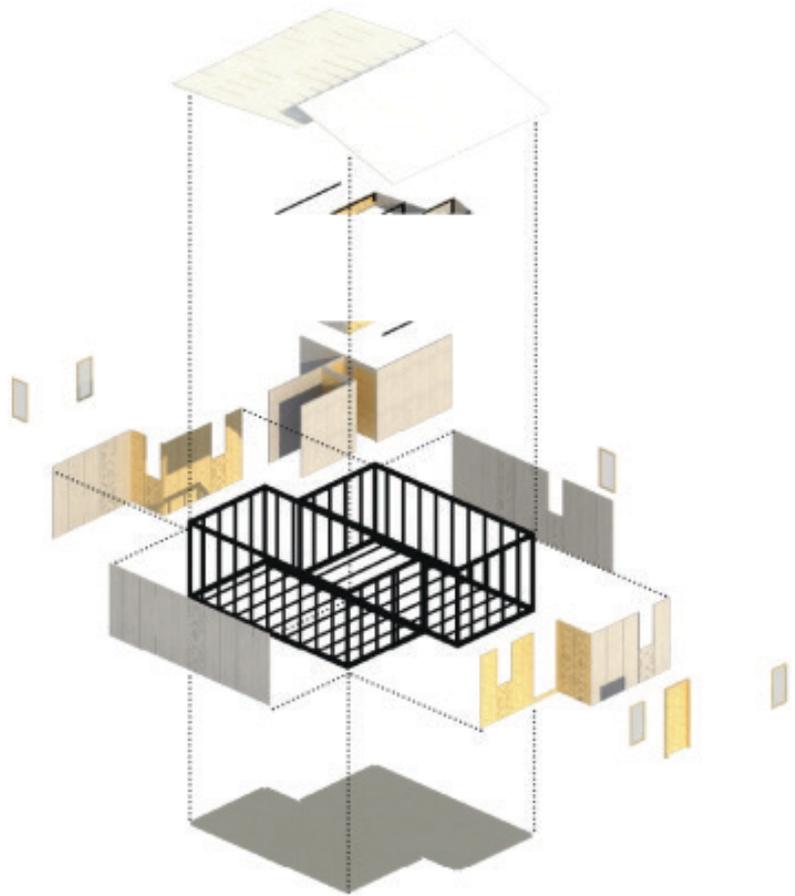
Spaccato assonometrico/ Axonometric cross-section
